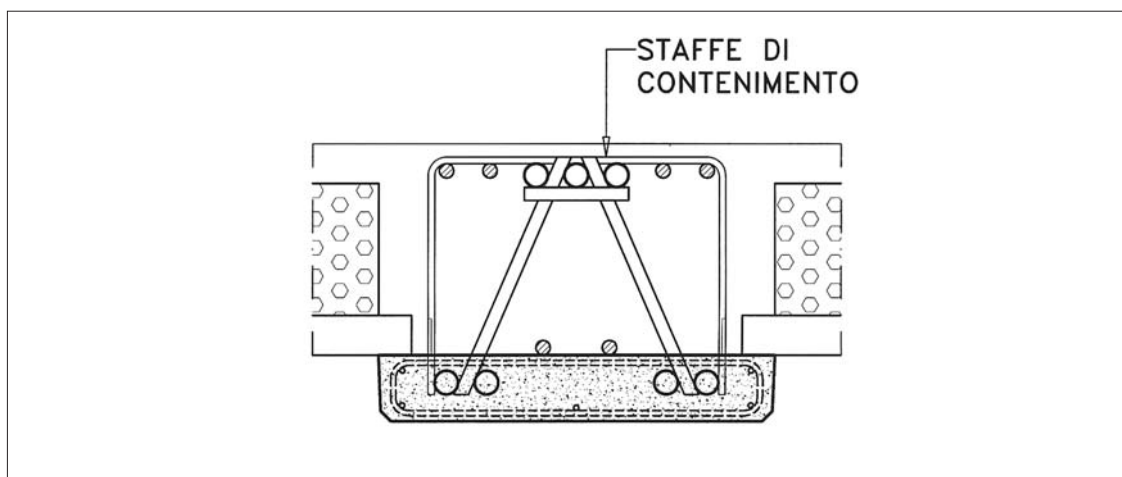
Sezione di testata con staffe aperte saldate ai correnti inferiori.
